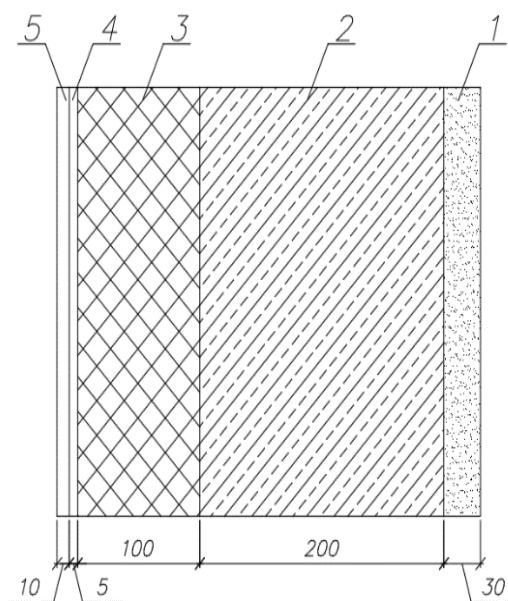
«Ограждающая конструкция стены жилого дома»[19]
